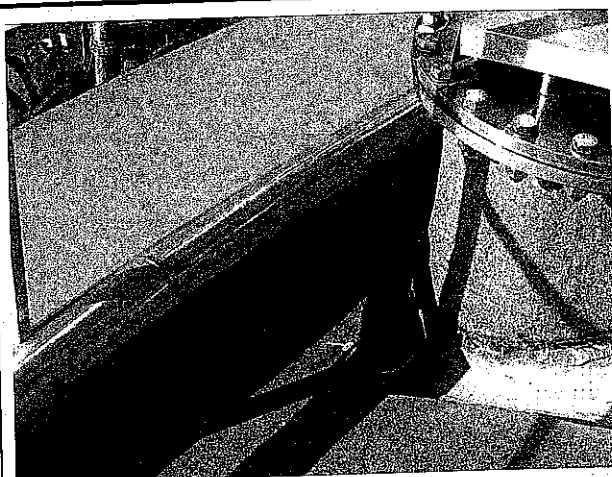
observons des défauts au niveau des relevés d'étanchéité, sur les acrotères et sur les souches.
